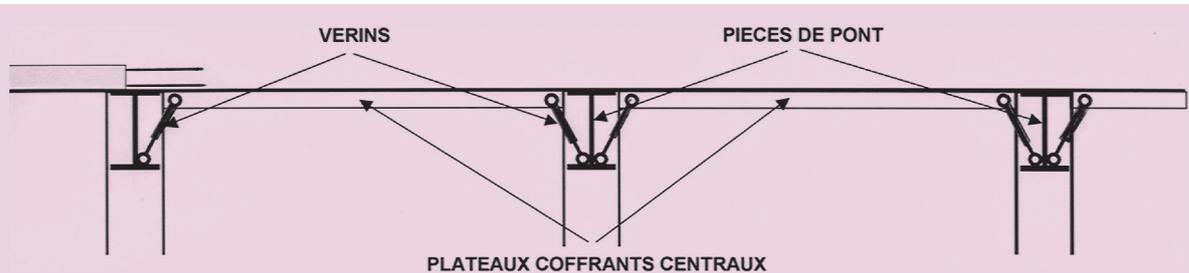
Conditions d'appui des plateaux coffrants en situation de bétonnage (le ferrailage du plot en construction n'est pas représenté)
